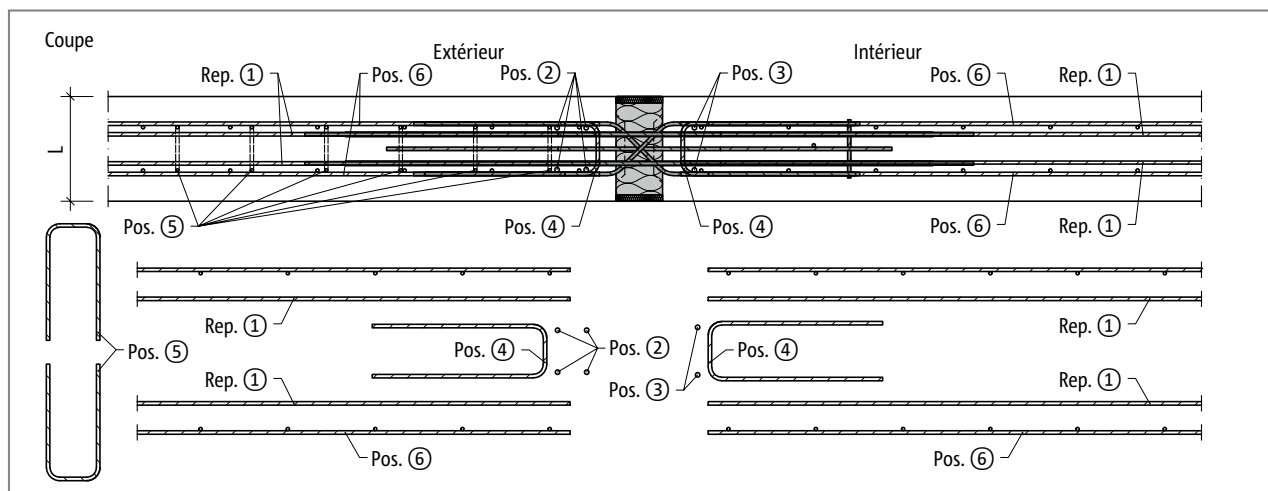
Schöck Isokorb® T Type W : Renforcement sur site (plan de base)
